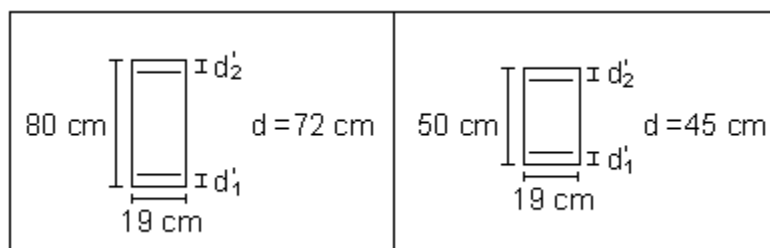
Seções transversais das vigas do Exemplo 3.
